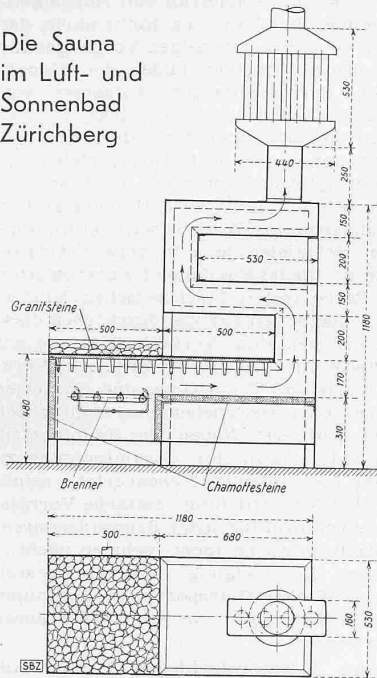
Zürcher Sauna-Ofen mit Gasfeuerung. Grundriss und Schnitt 1:30
